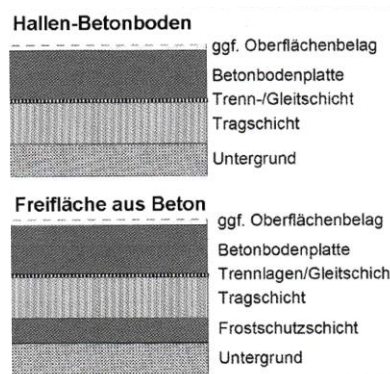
Aufbau eines Betonbodens für Hallen und Freiflächen [4]
